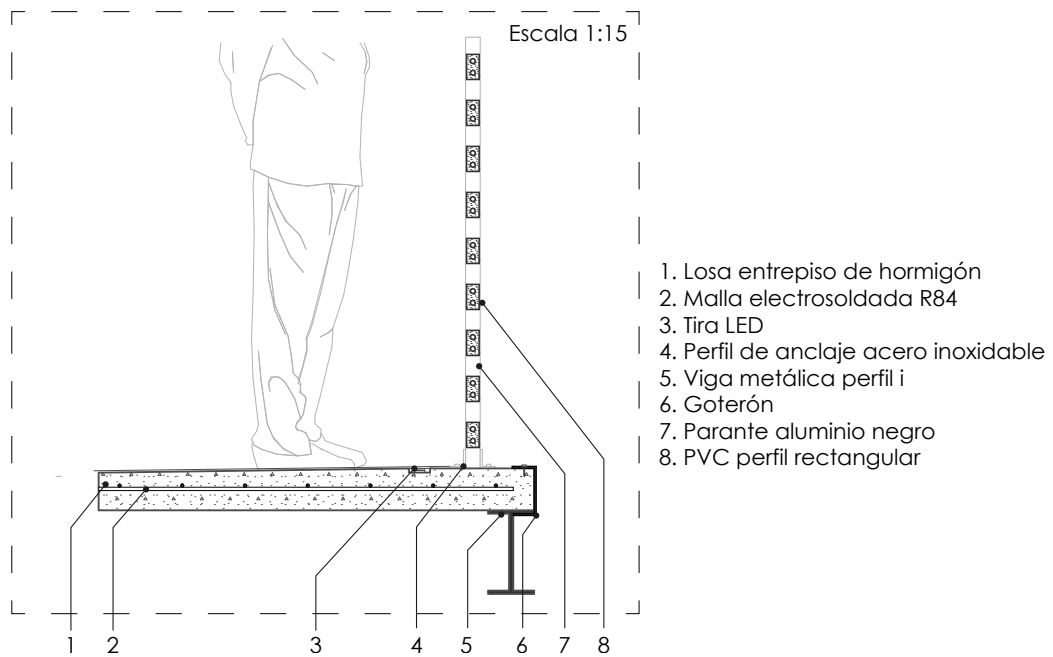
Detalle constructivo balcón de departamento y lamas PVC
